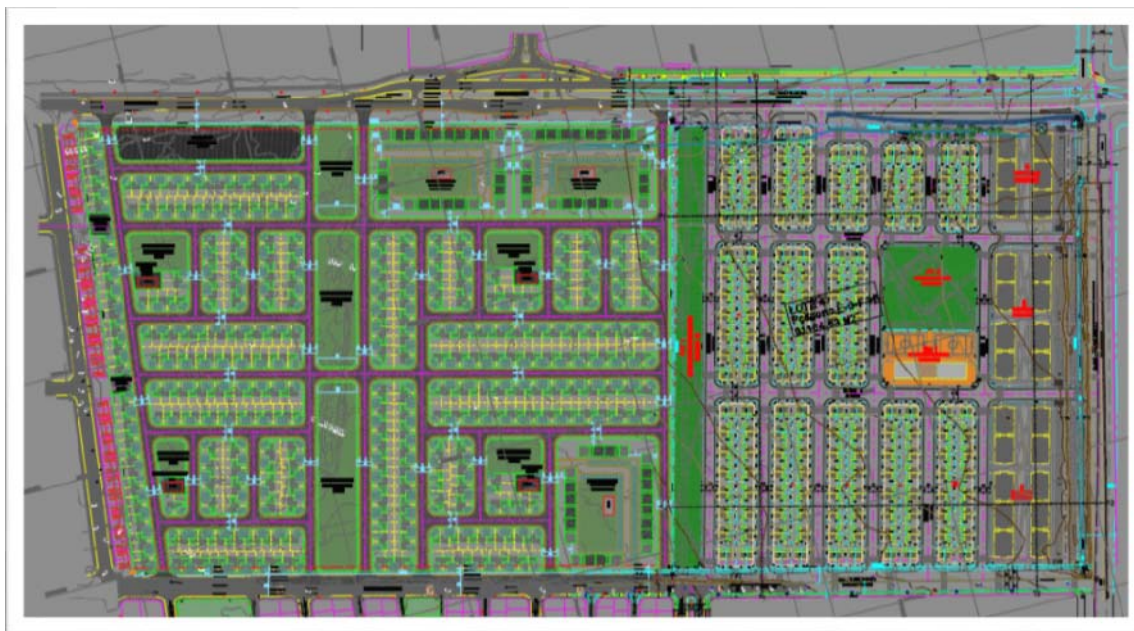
Plano de emplazamiento y conjunto de la propiedad El Mariscal
